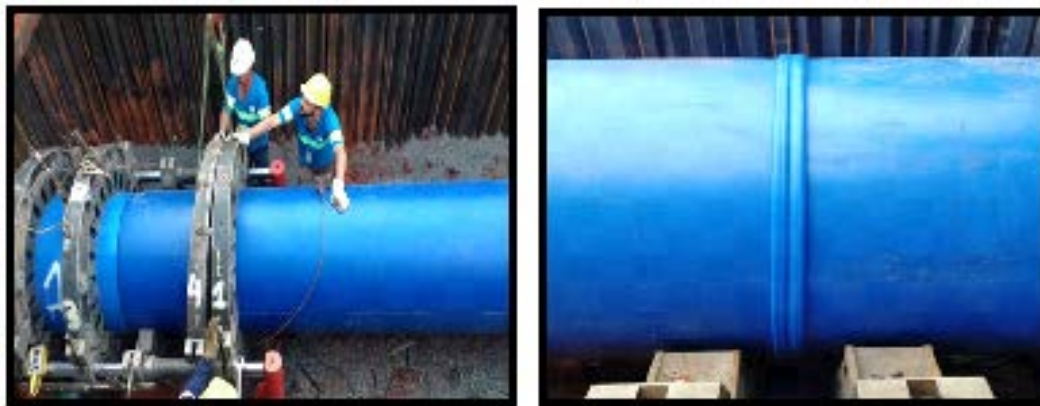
alinhamento, faceamento e soldagem da tubulação.
